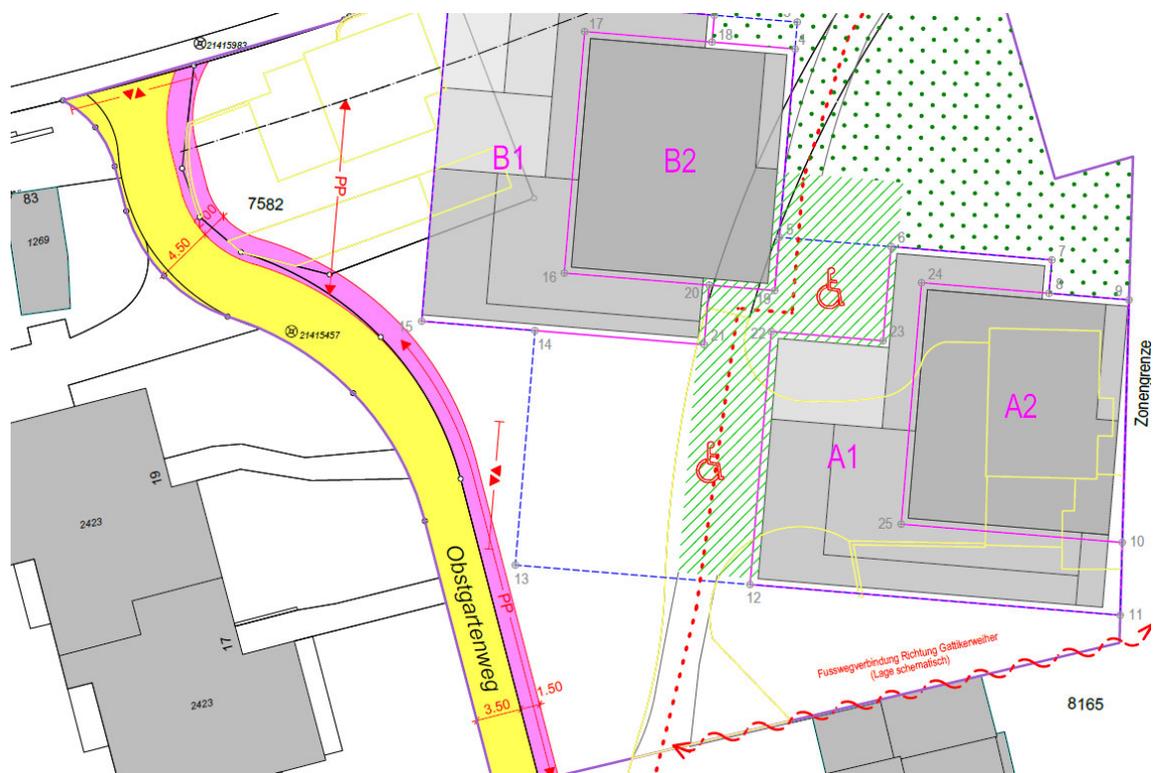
Ausschnitt Gestaltungsplan mit möglichem Ausbau des Obstgartenweg
